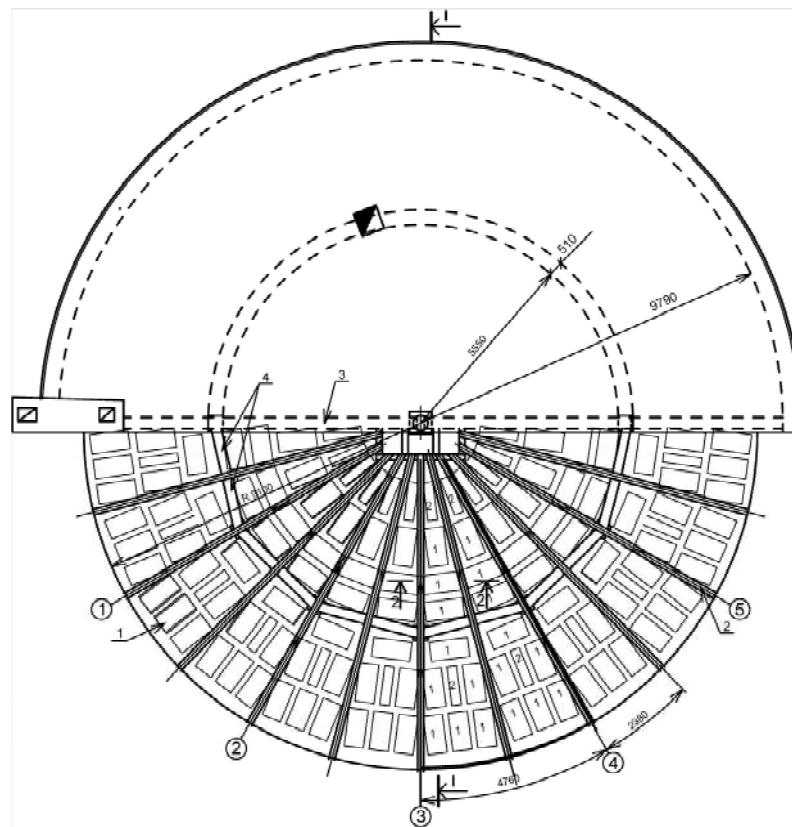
Конструктивна схема перекриття у плані після реконструкції:
